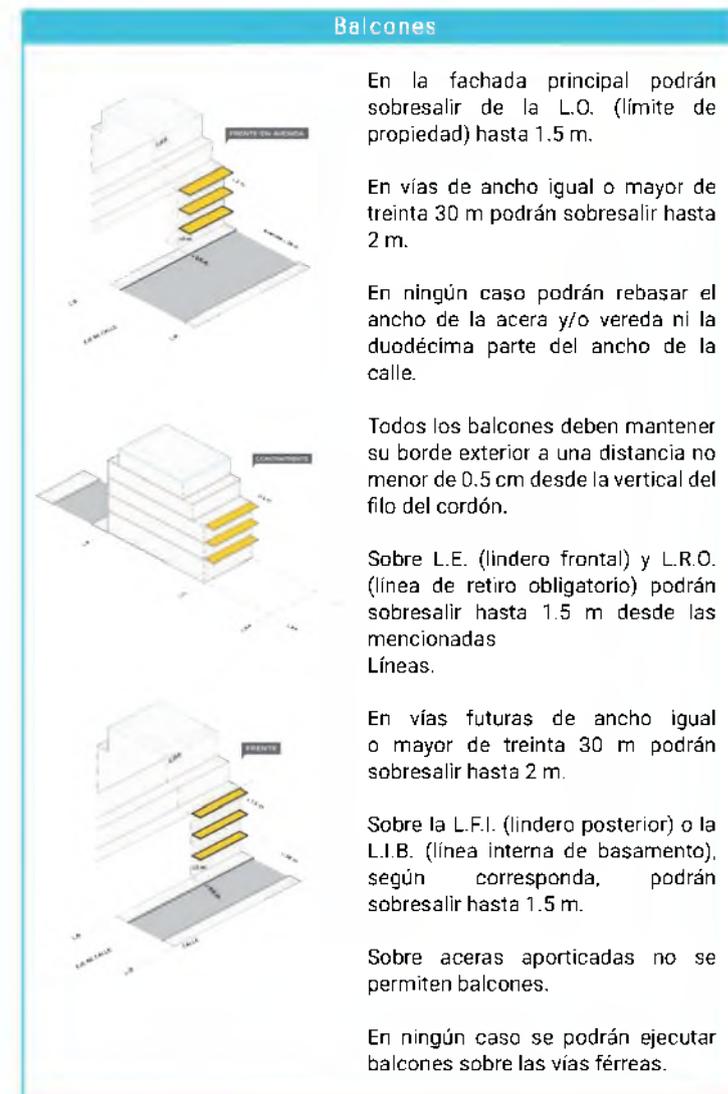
Resumen de Perfil Edificable y Balcones. Basado en el Código Urbanístico de Buenos Aires. MTYDU (2019).
